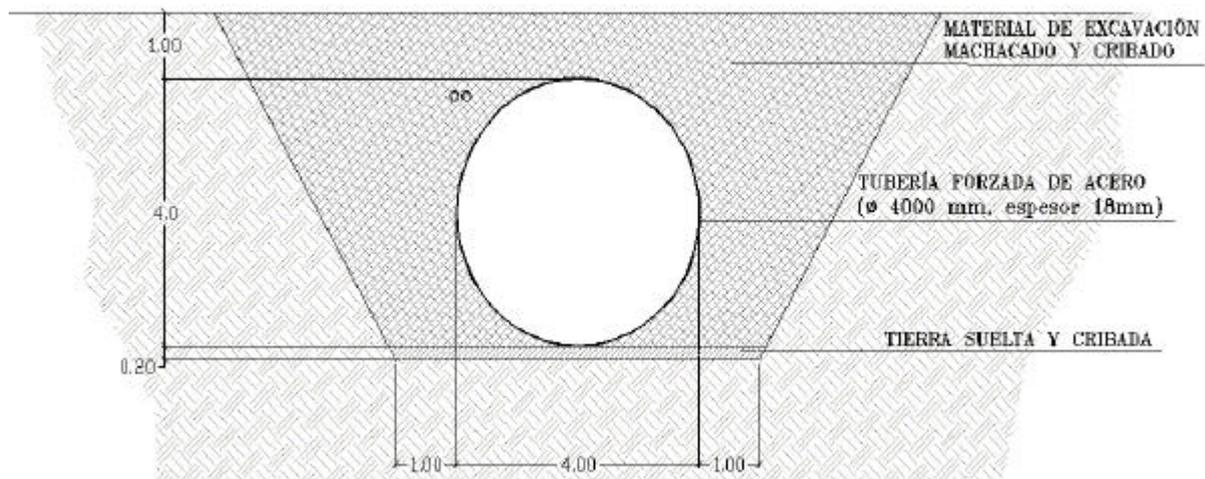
Vista de Corte de Instalación de la Cañería
